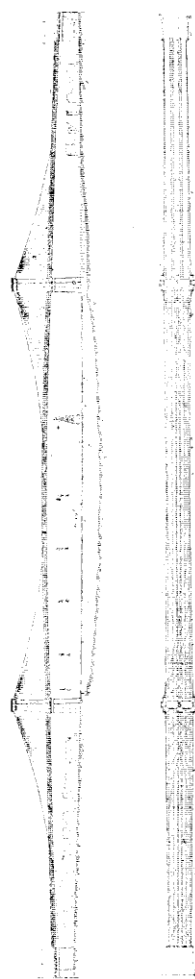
et 329. — Pont sur le Hudson, entre New-York et Brooklyn. (Élévation et Plan.)
